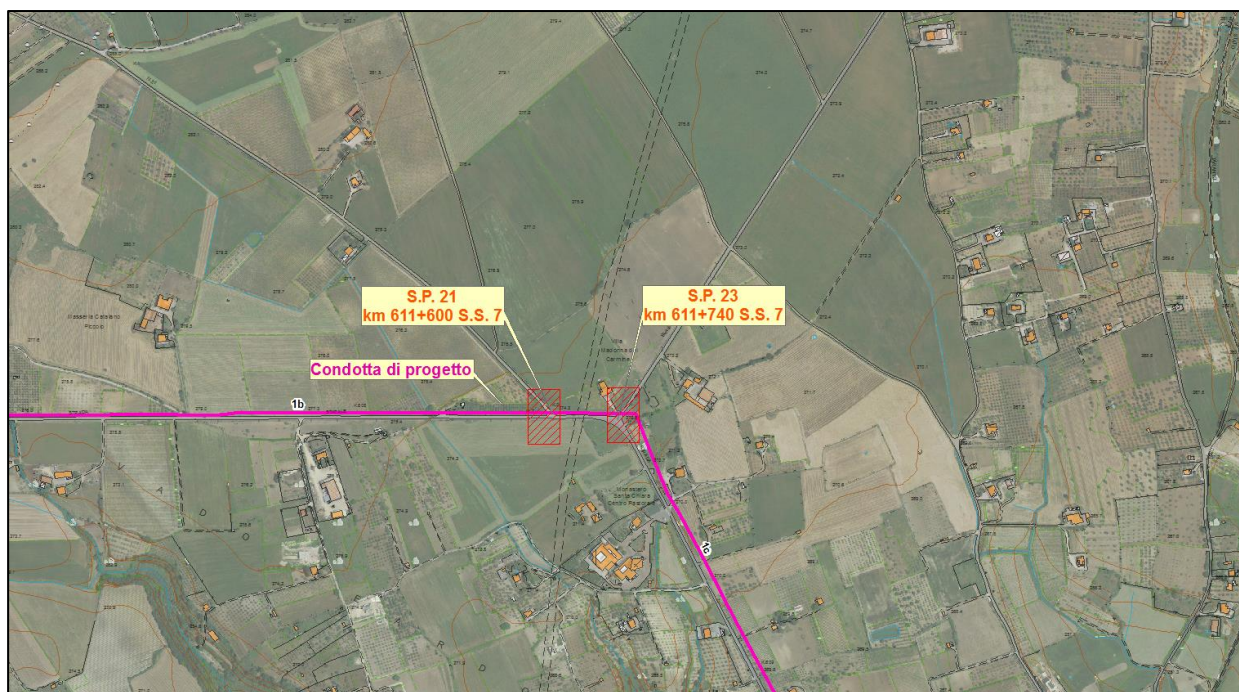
Stralcio planimetrico con individuazione dell'interferenza dell'intervento ID1b con la SP 21 e con la SP23
